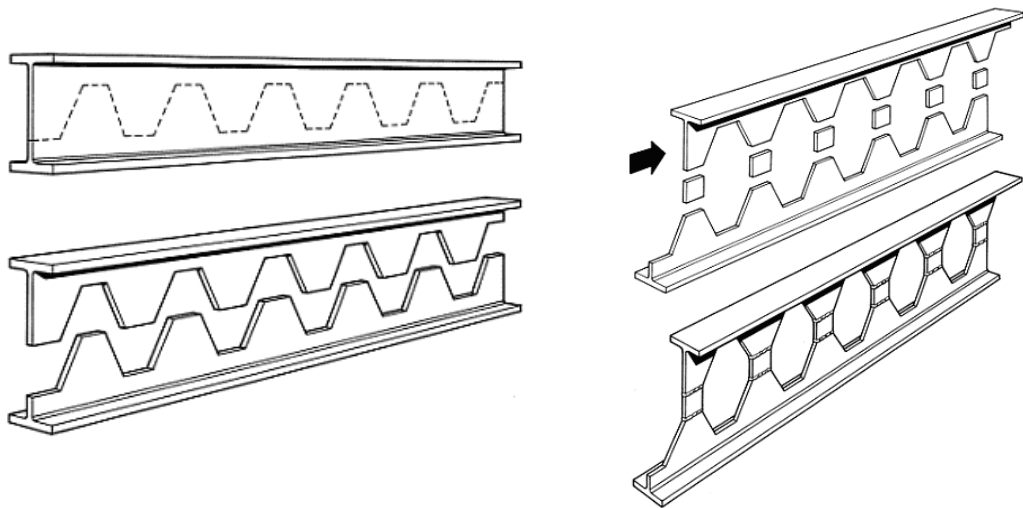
Processo de corte e fabricação de vigas alveolares (foto:WESTOK).
